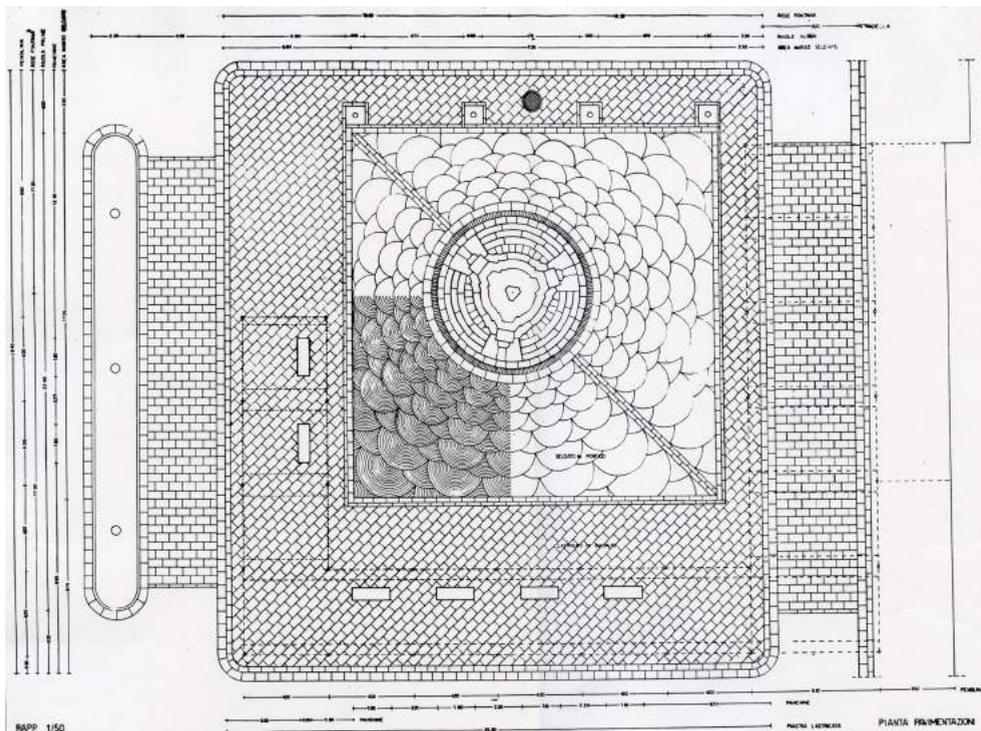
N.G. Leone, *Progetto di trasferimento della fontana Scelba nella piazza della ferrovia*, (1989). Pianta quotata, particolare della nuova pavimentazione; eseguito in c.a.d., stampato in b.n. su carta lucida, rapp. 1:50.
